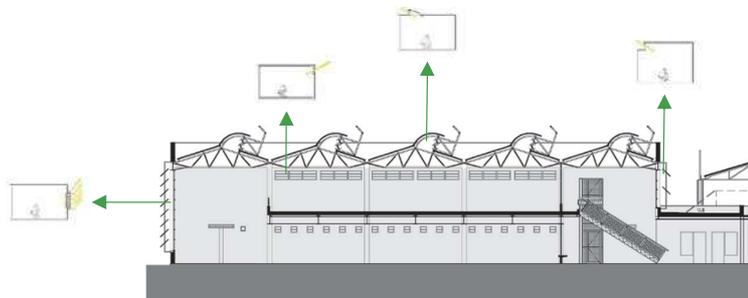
Corte longitudinal – Biblioteca. Fonte: Bloch Arquitetos, 2016
